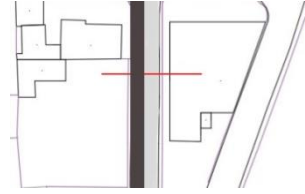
Plano Geral - Travessa Verdeiro do Carmo
